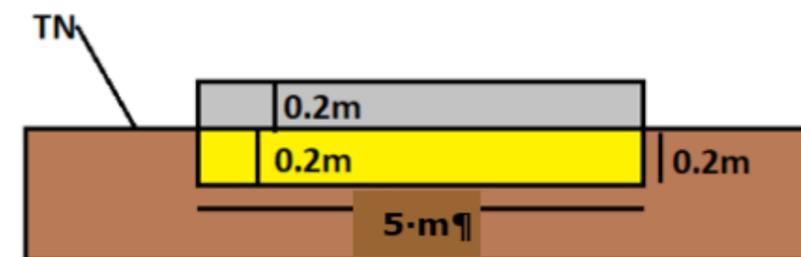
Coupe type d'une piste lourde (source : PHOTOSOL)
